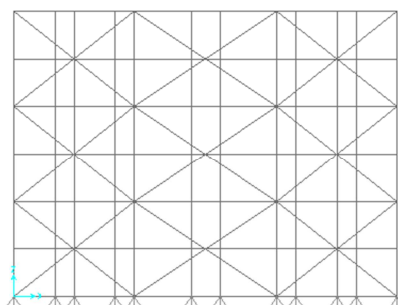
Configuração dos Planos de Contraventamento Vertical Com Elementos de Contraventamento Grandes
